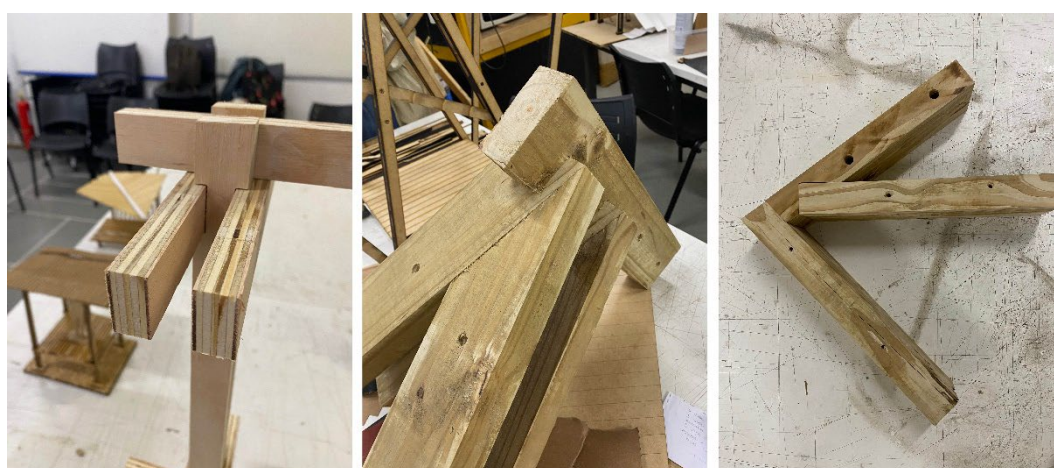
WCB, detalhes construtivos em escala 1:3 e 1:1.
